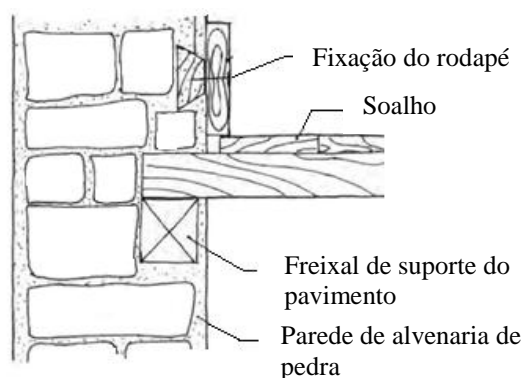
3 Ligação das vigas de pavimento às alvenarias de pedra, [3].
